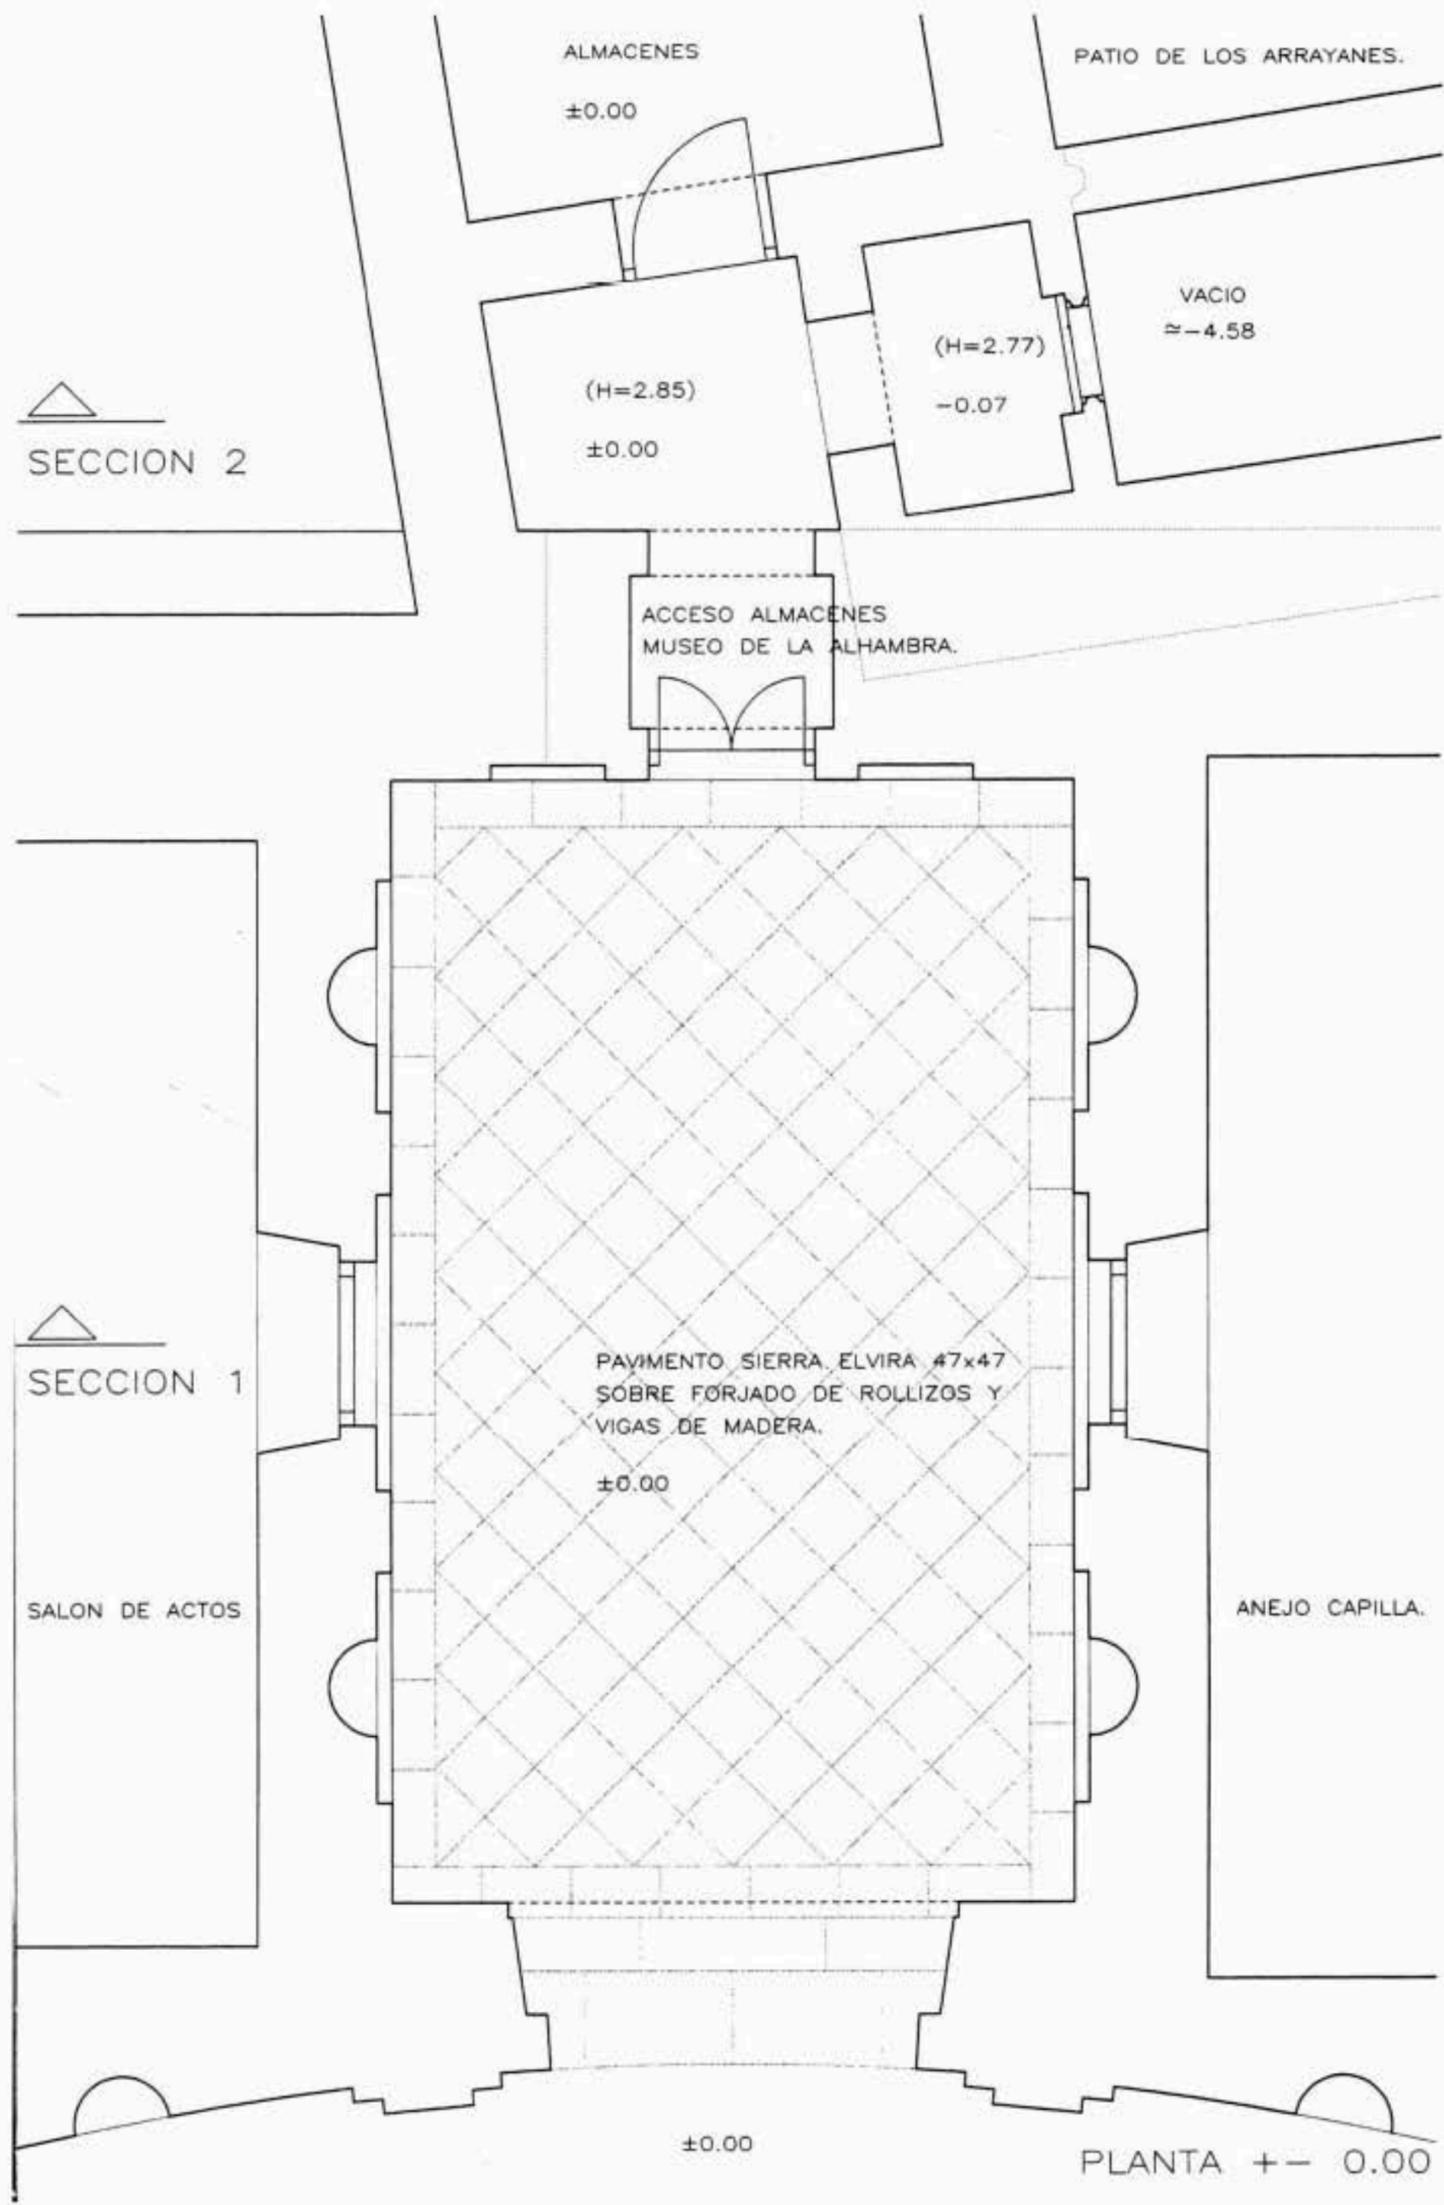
Estado Anterior. Planta cota +0,00 m.
